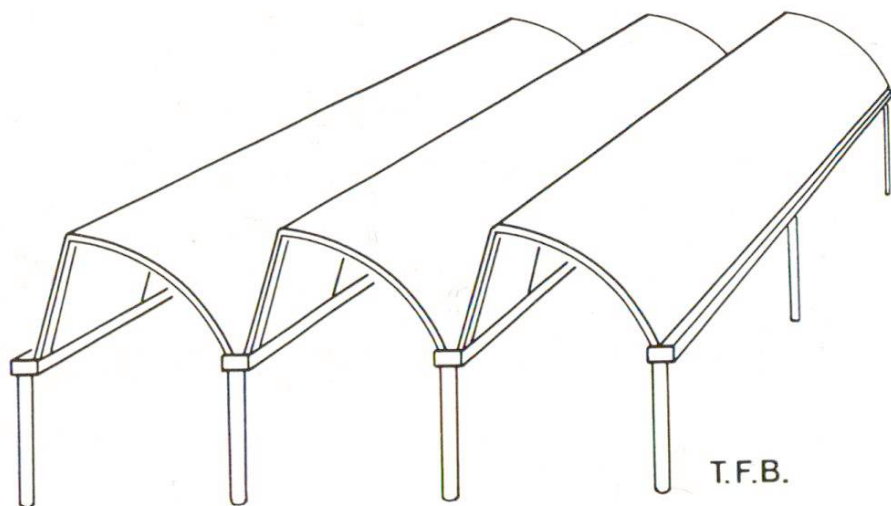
Construction en sheds avec dalle cylindrique de 6 cm d'épaisseur. Dans des constructions plus récentes de ce même type, les bords inférieurs des dalles sont précontraints
